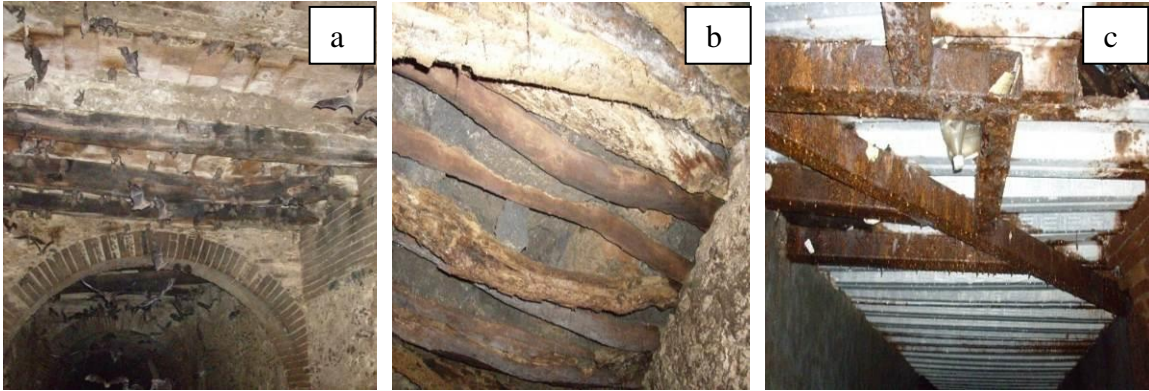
(a) Deterioro en estructura del embovedado de 4ª Norte y 4ª Oriente; (b) Corrosión en estructura del embovedado del barrio San Roque; (c) Deterioro y corrosión de la estructura del embovedado de 5ª Poniente en el Barrio Guadalupe. Las fotografías corresponden al recorrido realizado por personal de Protección Civil Estatal y Protección Civil Municipal durante el mes de marzo de 2008.
